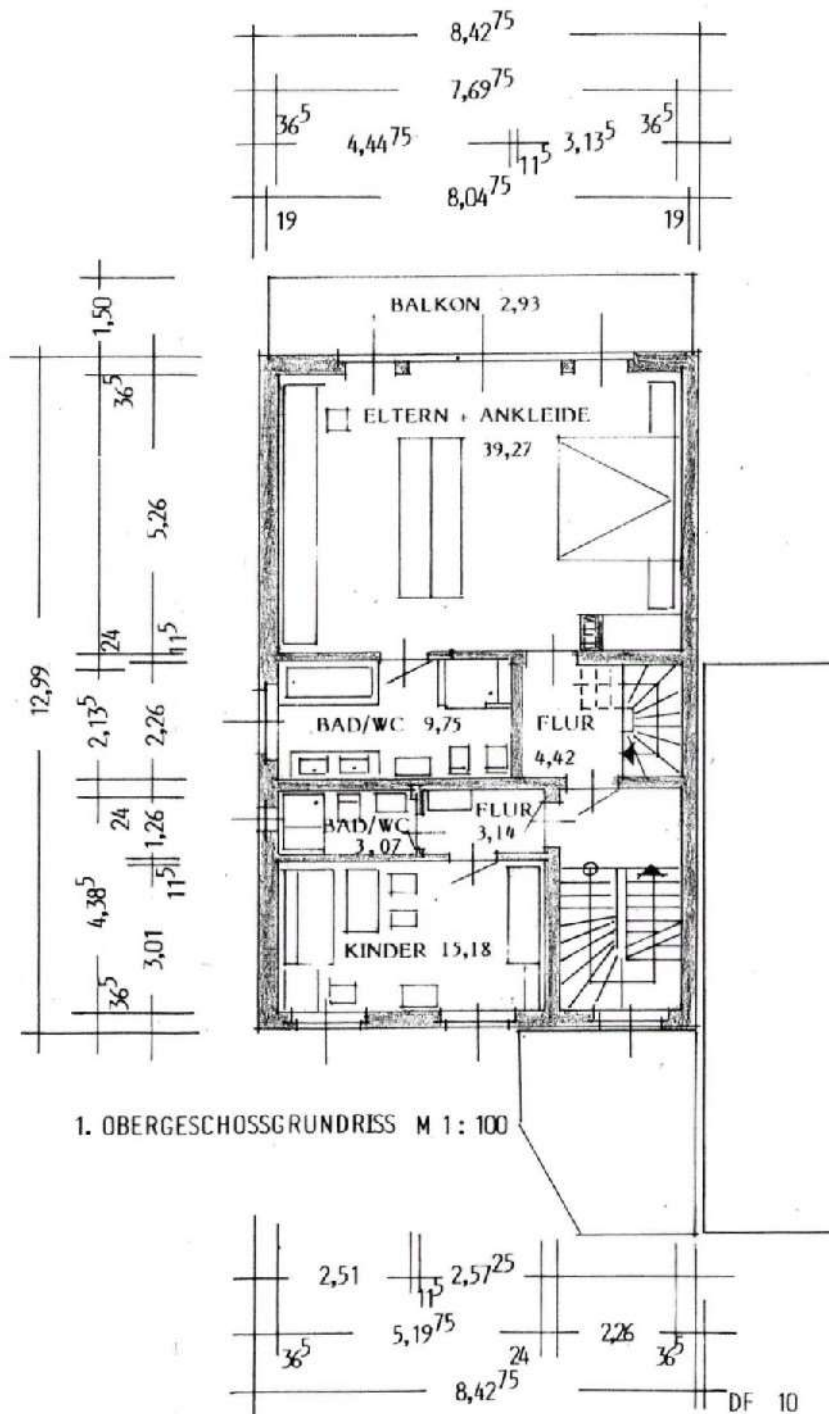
Grundriss 1.OG Quelle: Unterlagen der Gläubigerin
